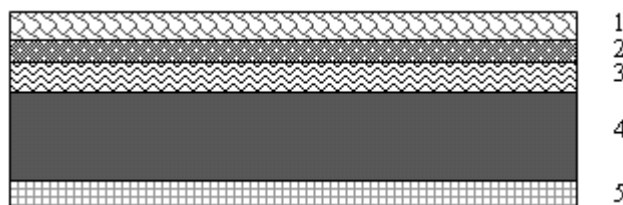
Coupe verticale du plancher courant à dalle pleine.
